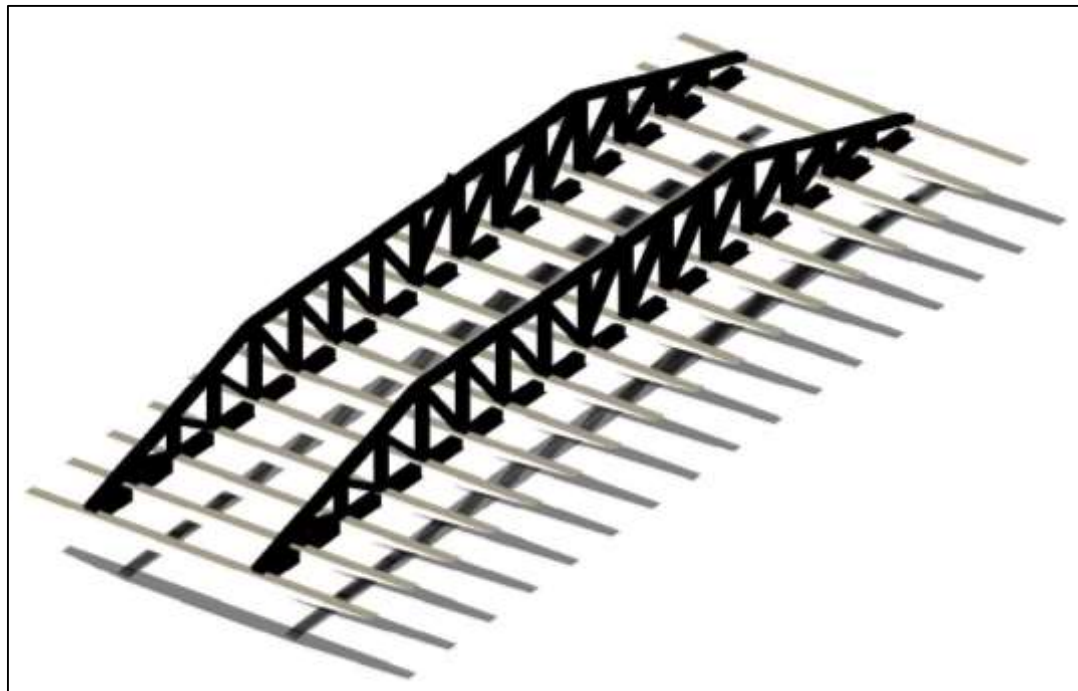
Vista general de la estructura metálica. Fuente: Elaboración propia.
